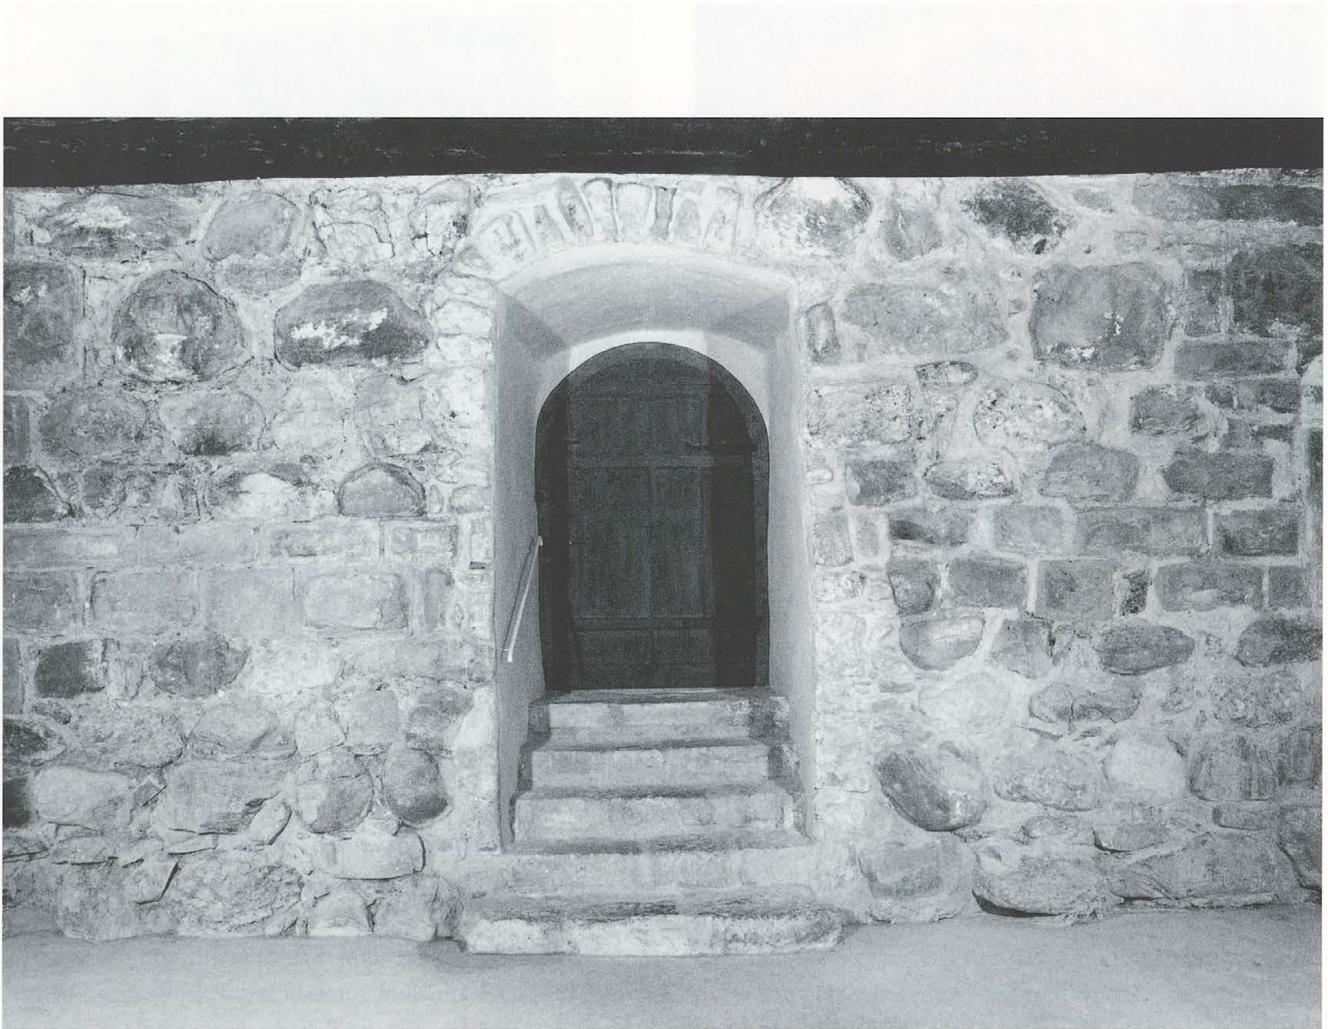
Burg Zug, Nordannex. Erdgeschoss-Raum (RN 2–4). Fundament und Mauerwerk der Turm-Nordfront (nach der Restaurierung).
